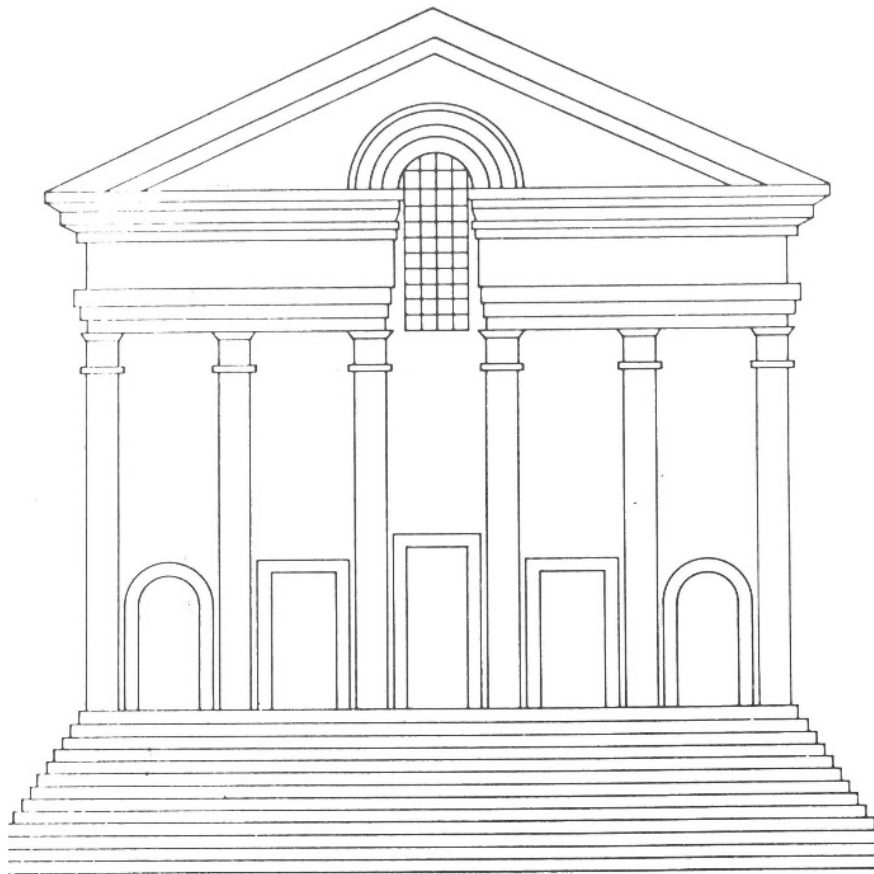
Reconstrucción de la fachada según el proyecto de Alberti<sup>780</sup>.
